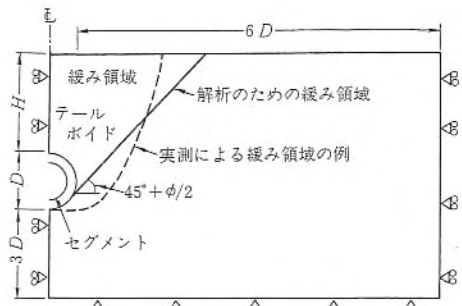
横断解析断面モデル<sup>260)</sup>
